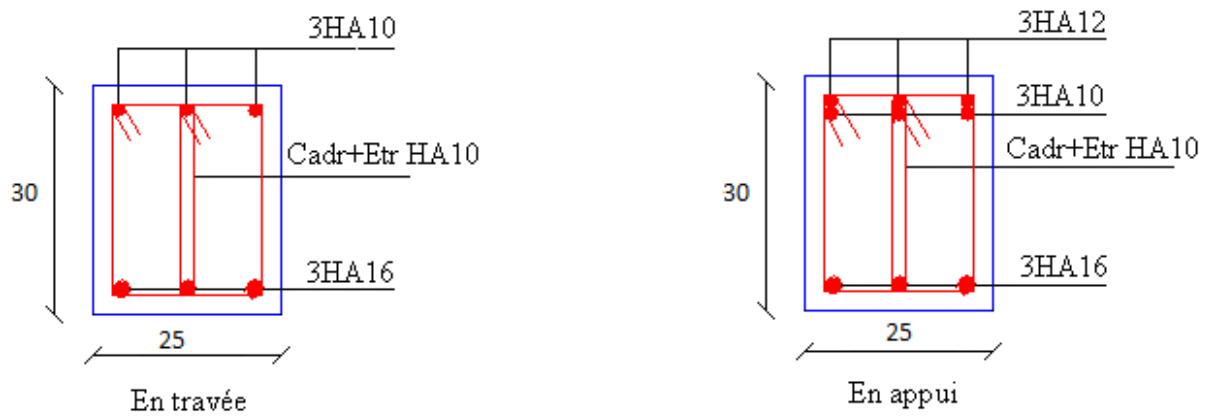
Schéma du ferrailage des poutres secondaires d'étage terrasse
